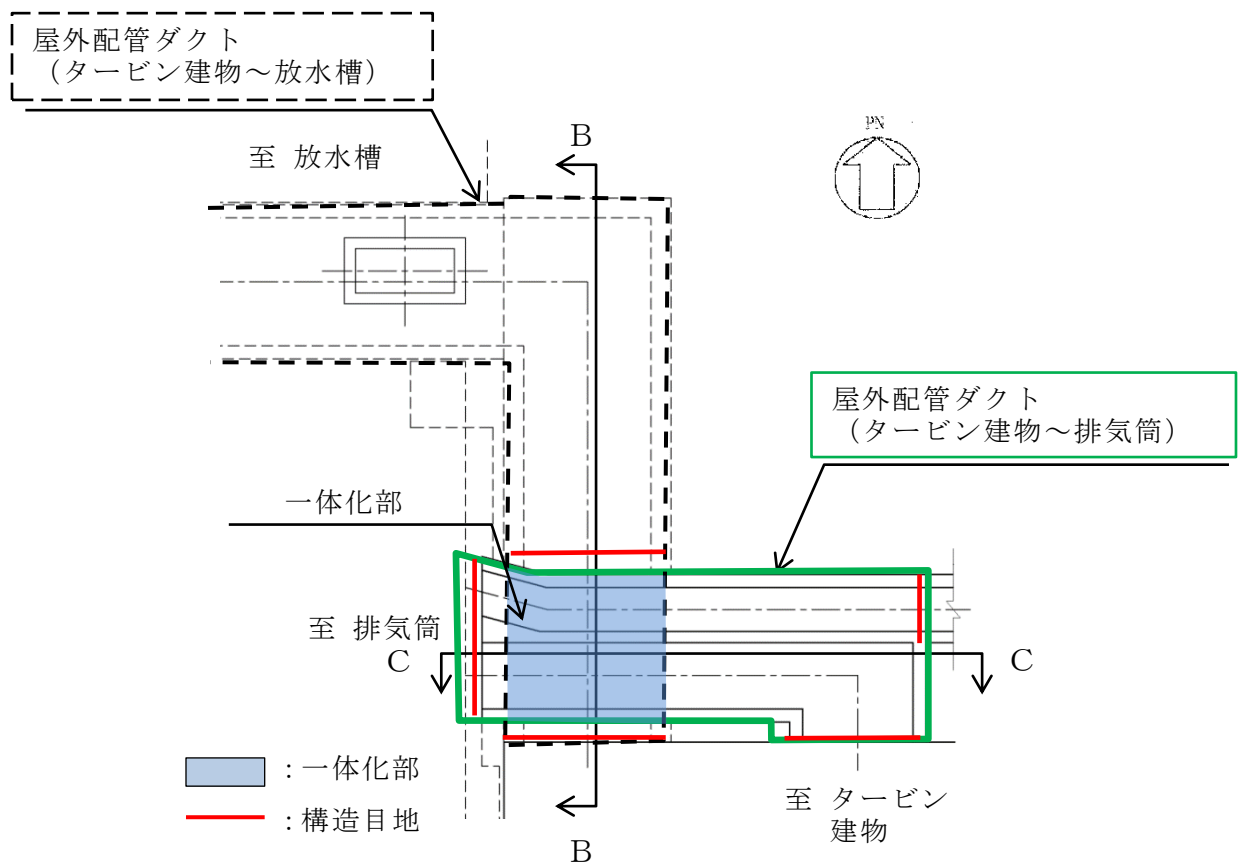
屋外配管ダクト（タービン建物～排気筒） 平面図
